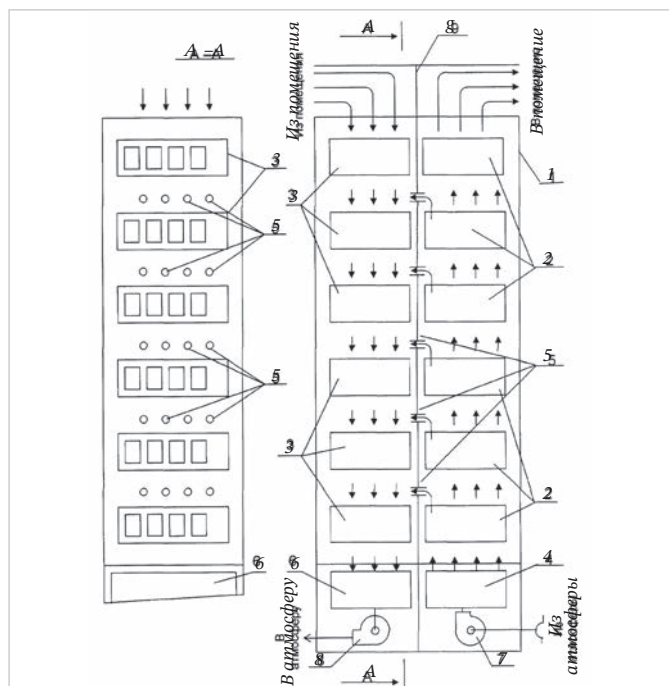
Схематическое изображение шкафа с нумерованными ссылками на его наполнение
